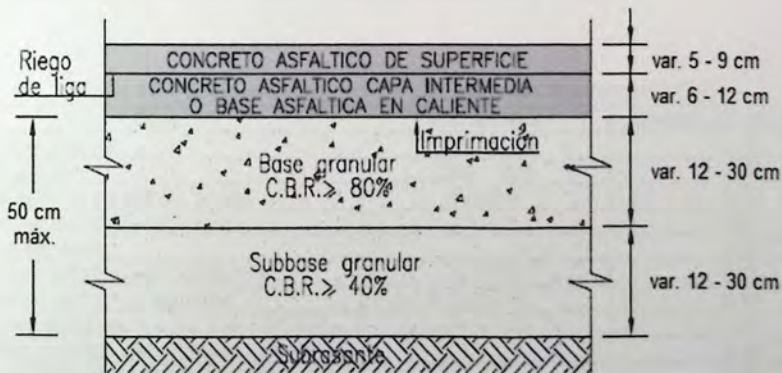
Perfil tipo pavimento flexible. [15]
